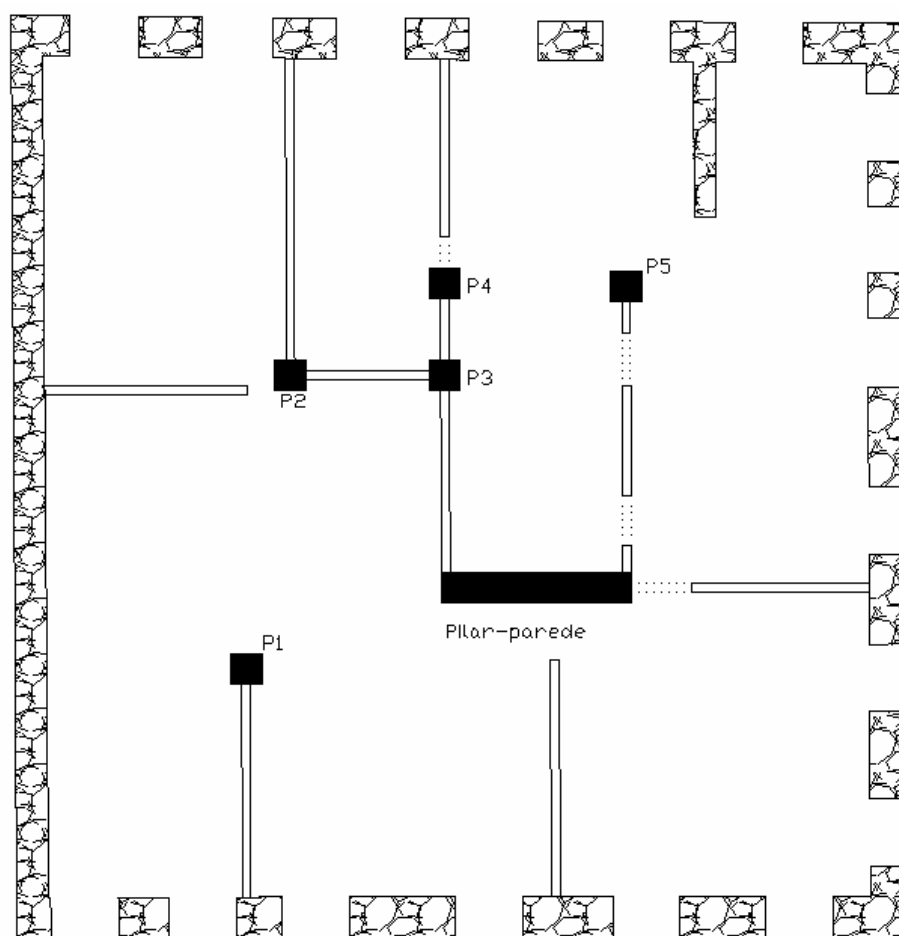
Planta do piso tipo com identificação dos elementos verticais considerados no piso térreo. Planta considerada na modelação do edifício
